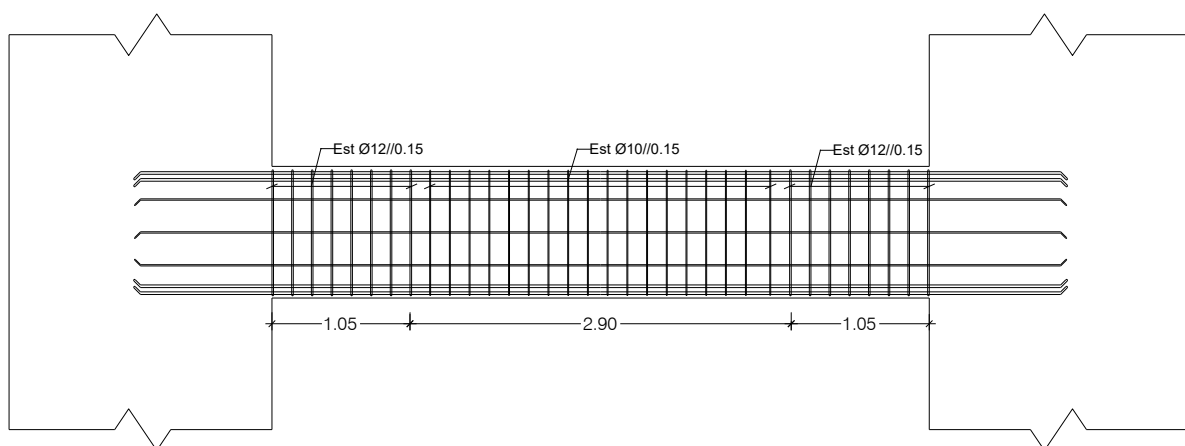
Secção longitudinal da viga de acoplamento PA_75%
